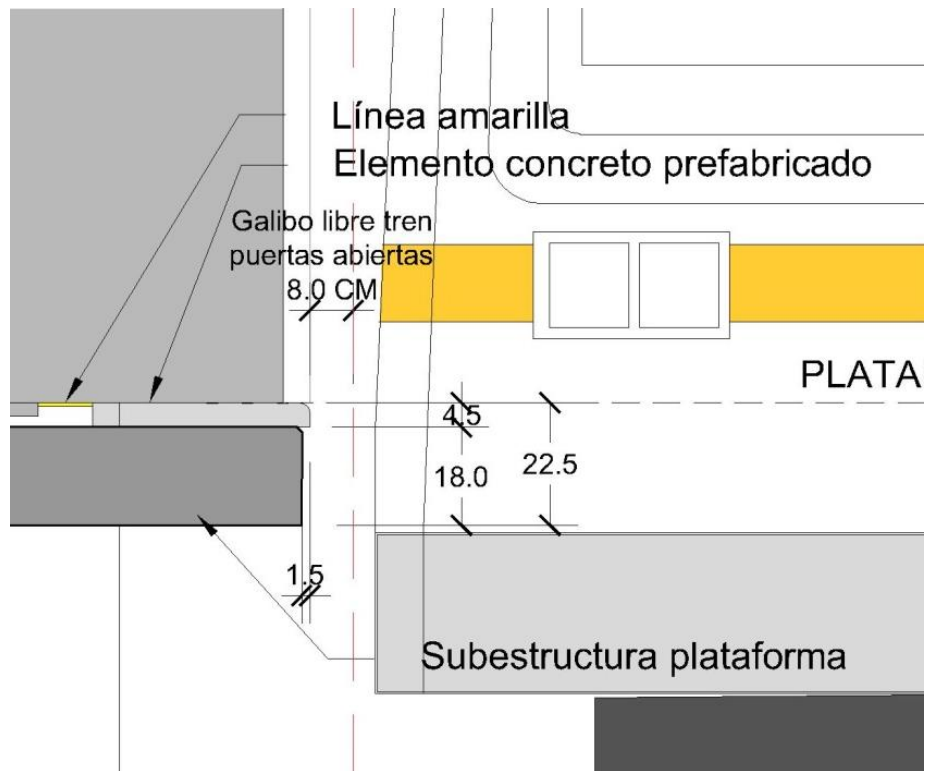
Detalle 1.2 Dimensiones de plataforma y galibo libre
